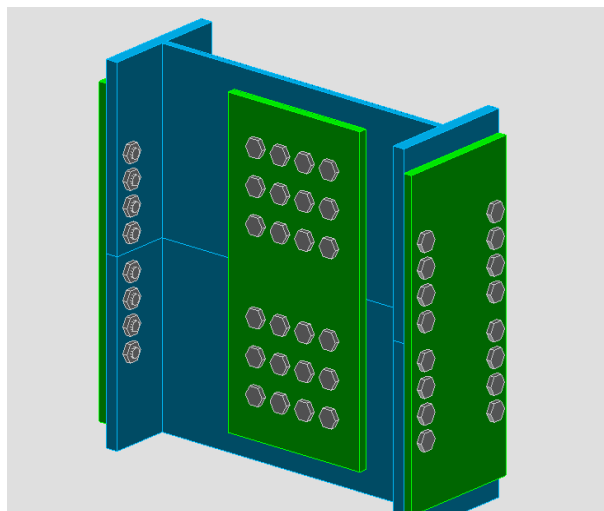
Assemblage poteau-poteau HEA800-HEA800
